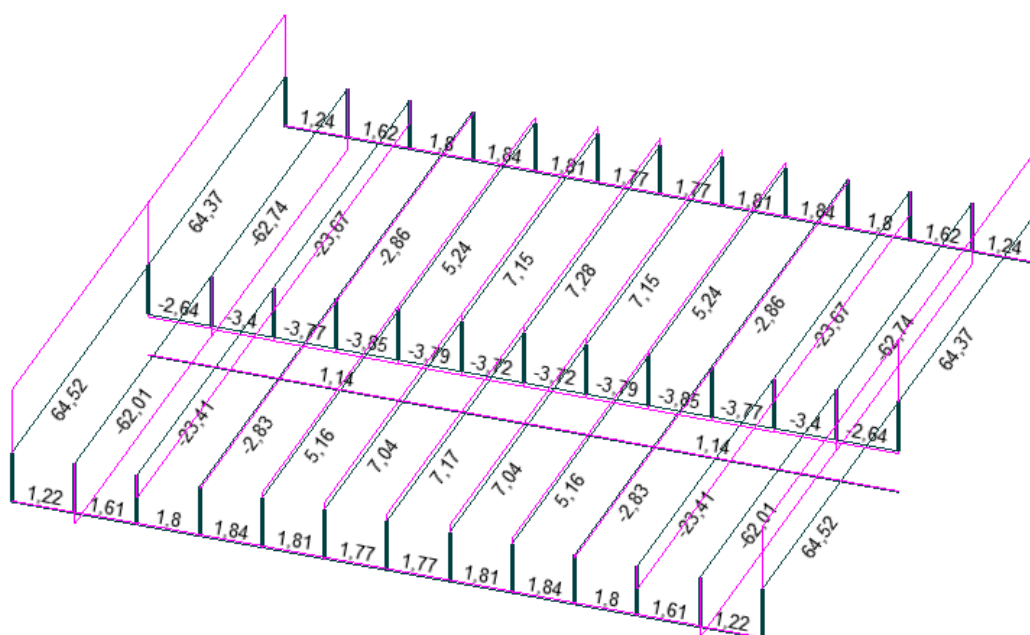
Балки перекрытия. Эпюры усилий N.
